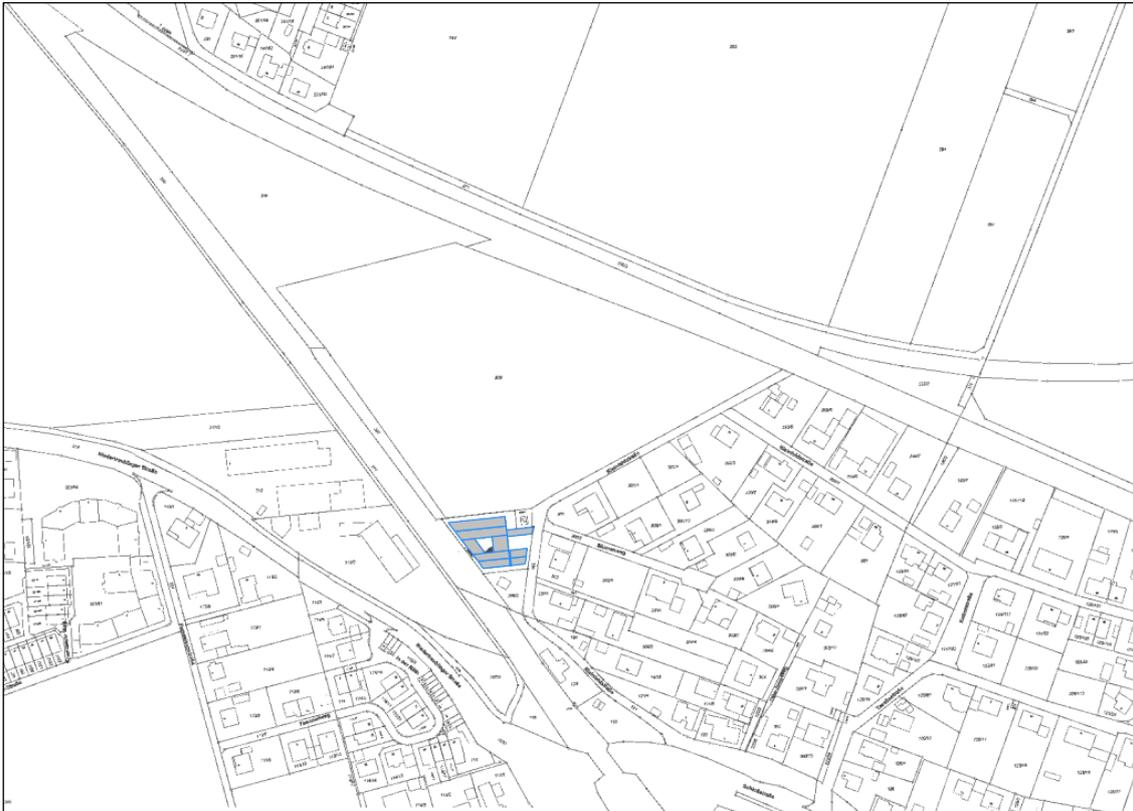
Lageplan mit dem geplanten Demenzpflegeheim
